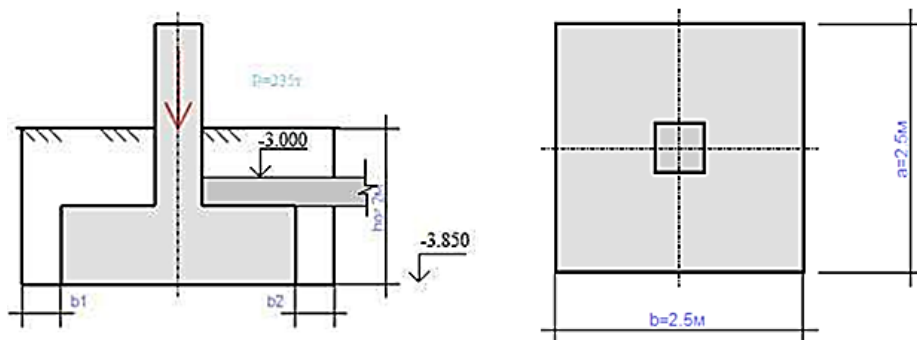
Конструктивне рішення фундаменту Фк - 1
